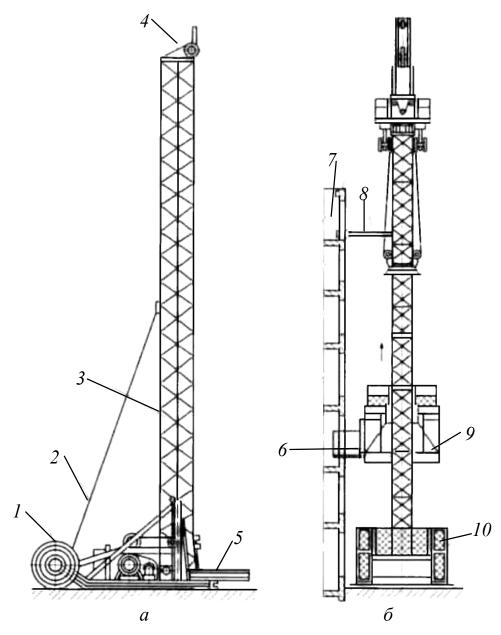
Мачтовые подъемники: а — грузовой, б — грузопассажирский; 1 — колесо, 2 — опорная рама, 3 — мачта, 4 — блок грузового каната, 5 — грузовая платформа, 6 — площадка, 7 — здание, 8 — крепление мачты к зданию, 9 — кабина, 10 — ограждение
